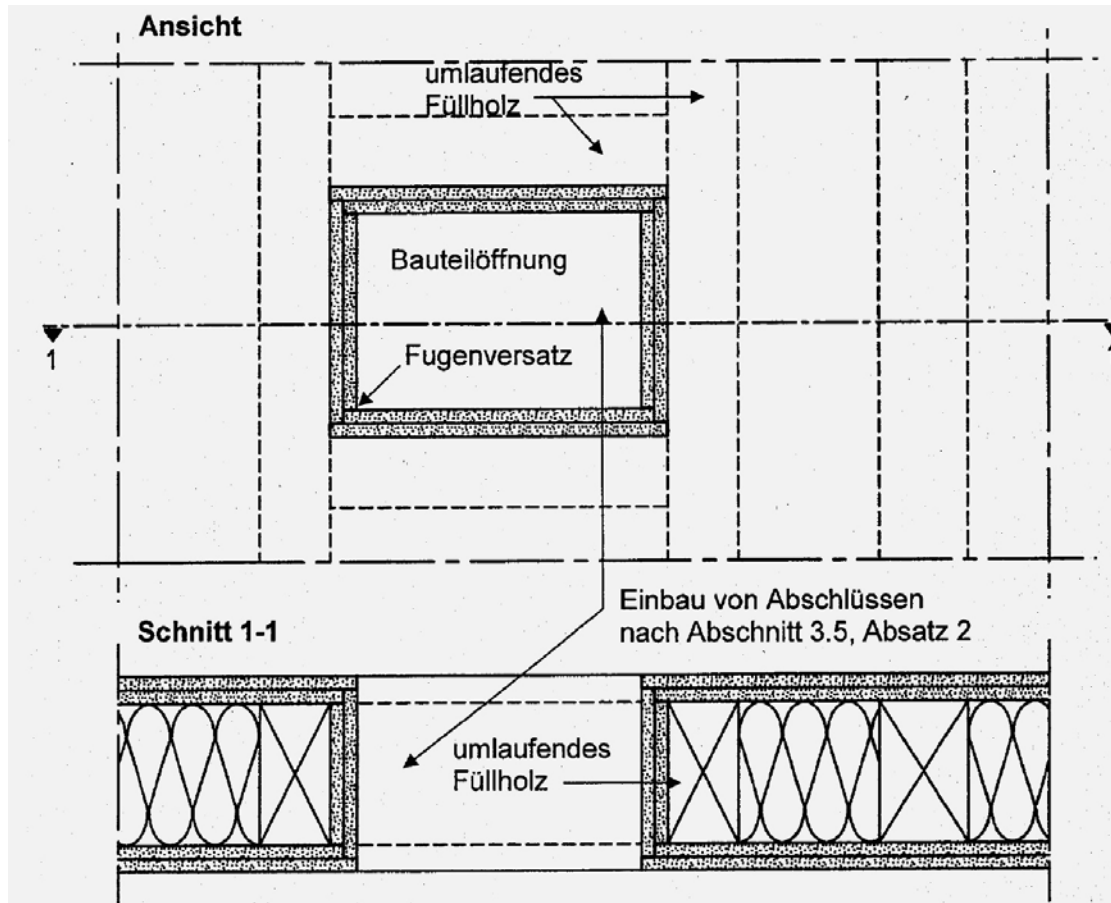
Bauteilöffnung mit Brandschutzbekleidung nach Abschnitt 3.2 zum Einbau von Türen, Fenstern und sonstigen Einbauten nach Abschnitt 3.5
